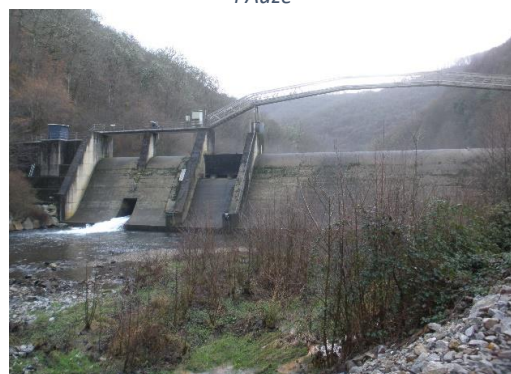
Photographie du barrage de Lavergne sur le Rau de Piallevedel
